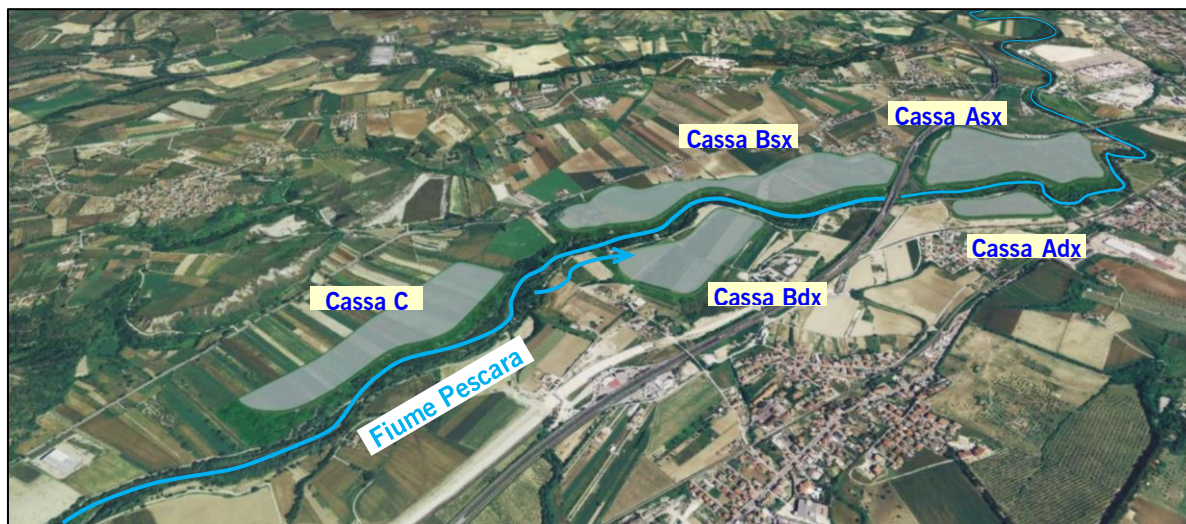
Vista dell'area interessata dall'intervento (A, B e C indicano la posizione delle casse).
